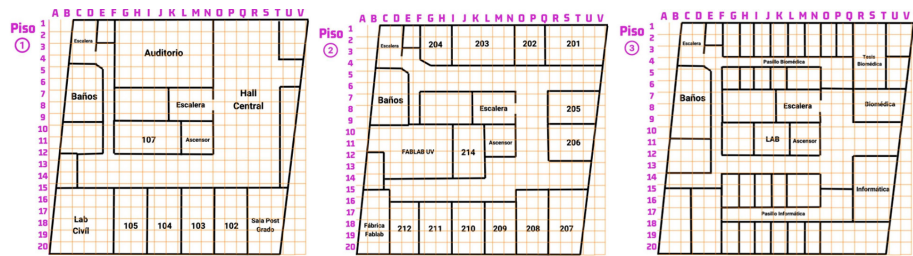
Planos esquemáticos de los 3 pisos considerados en el levantamiento.
